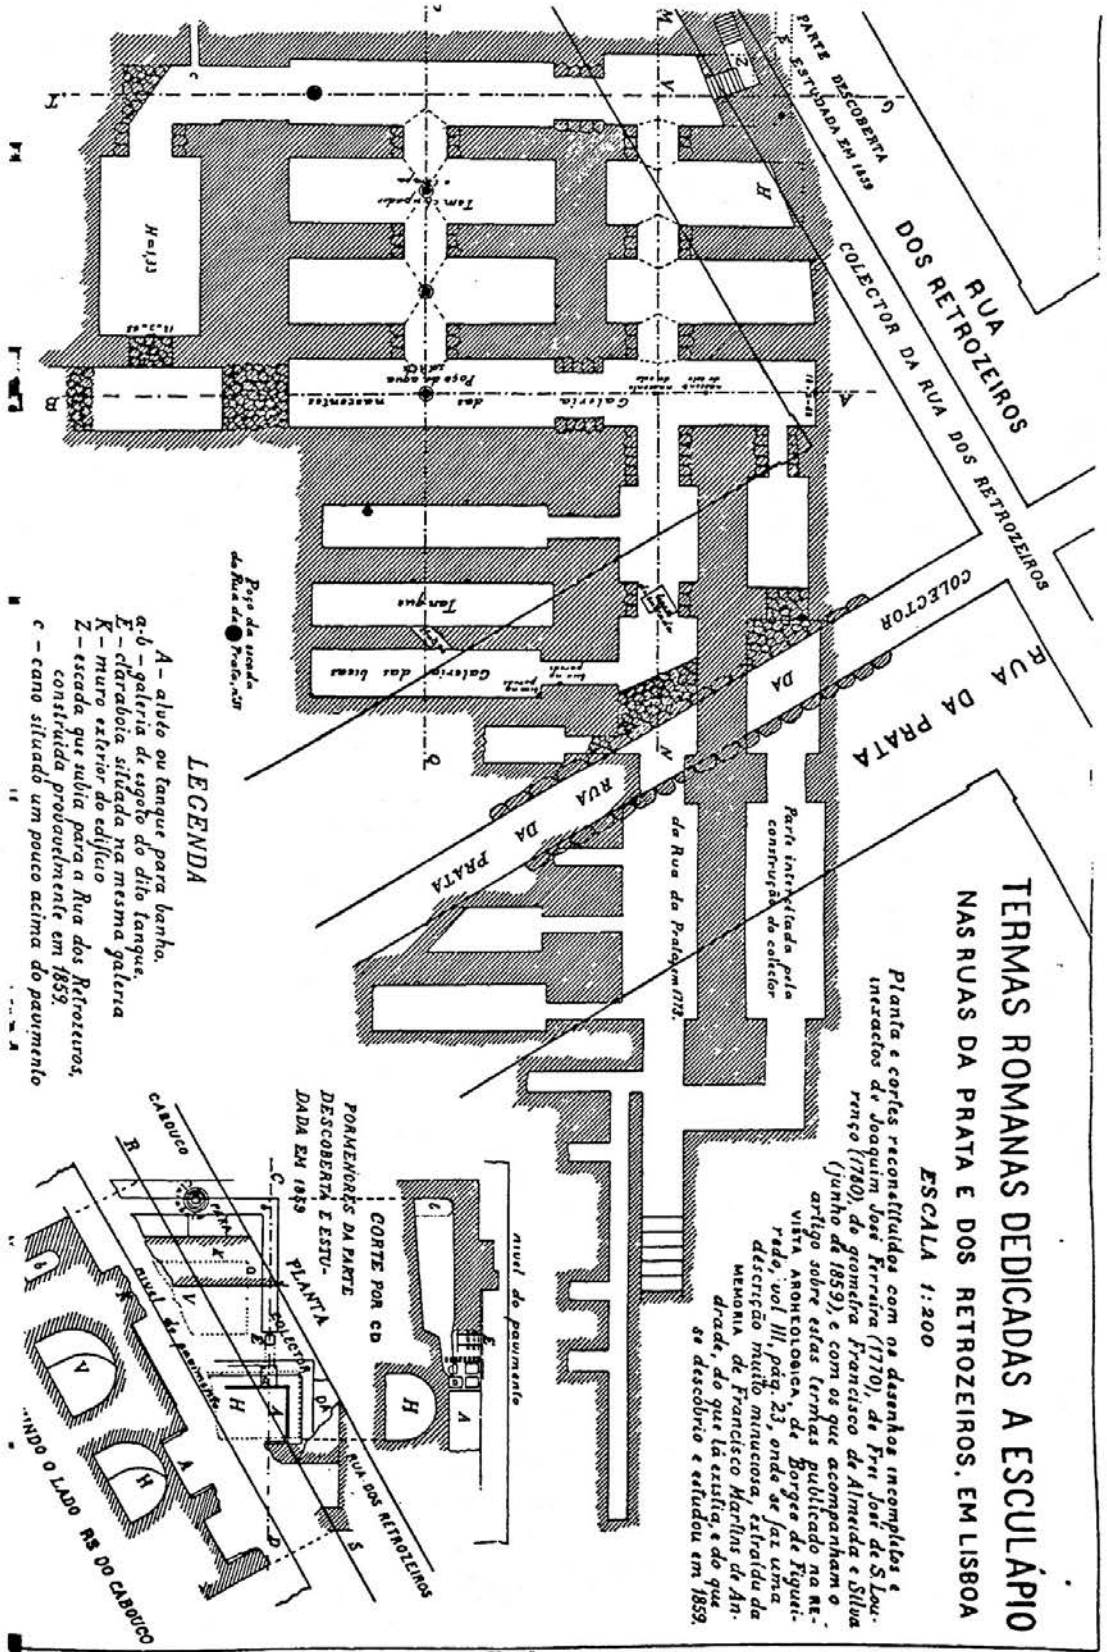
Olisipo*. Planta de las estructuras halladas en la Rua da Prata. —Según Borges de Figueiredo.
